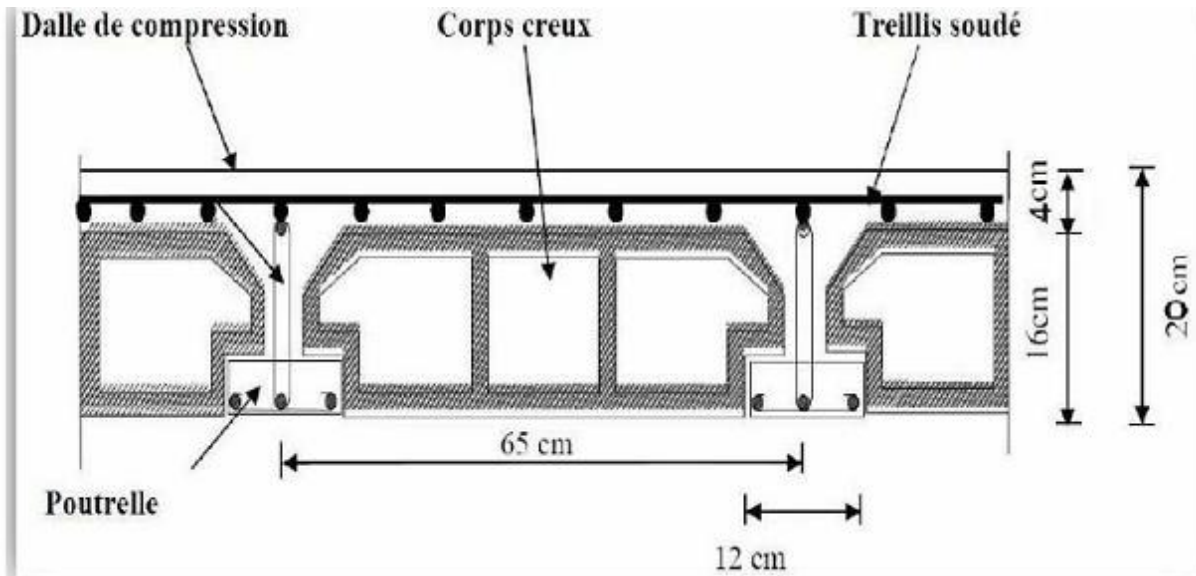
Schéma descriptif d'un plancher en corps creux
